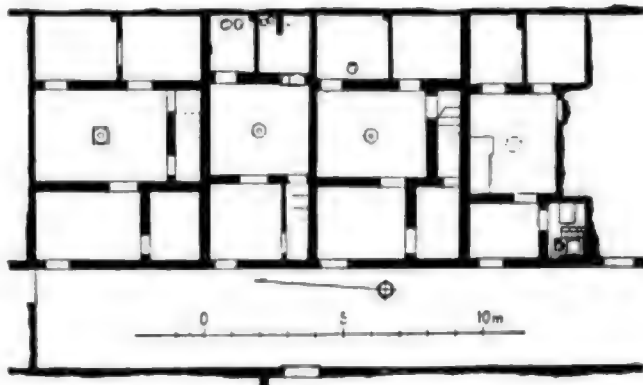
GRUNDRISS VON VIER ÄGYPTISCHEN WOHNHÄUSERN bei Tell-el-Amarna.
